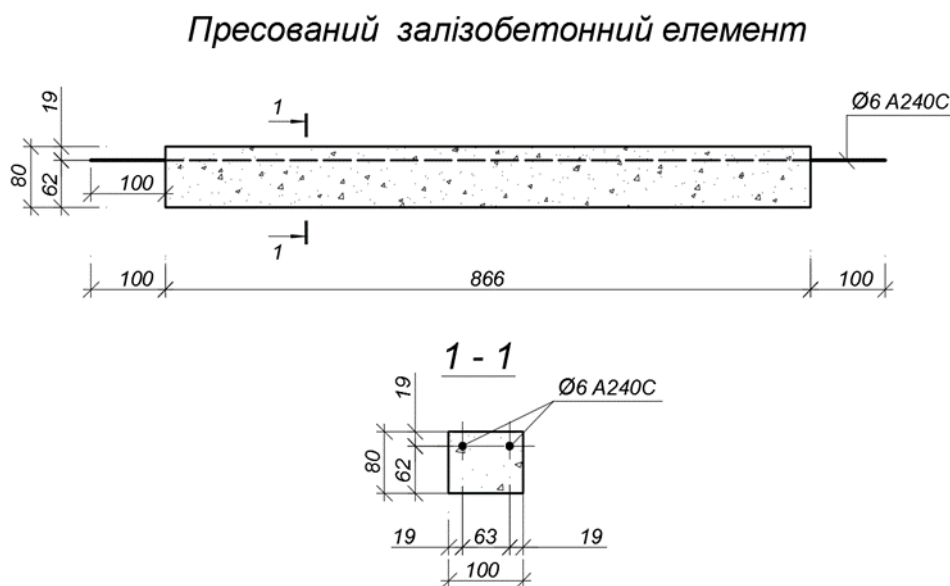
Пресований залізобетонний елемент (вкладиш)
